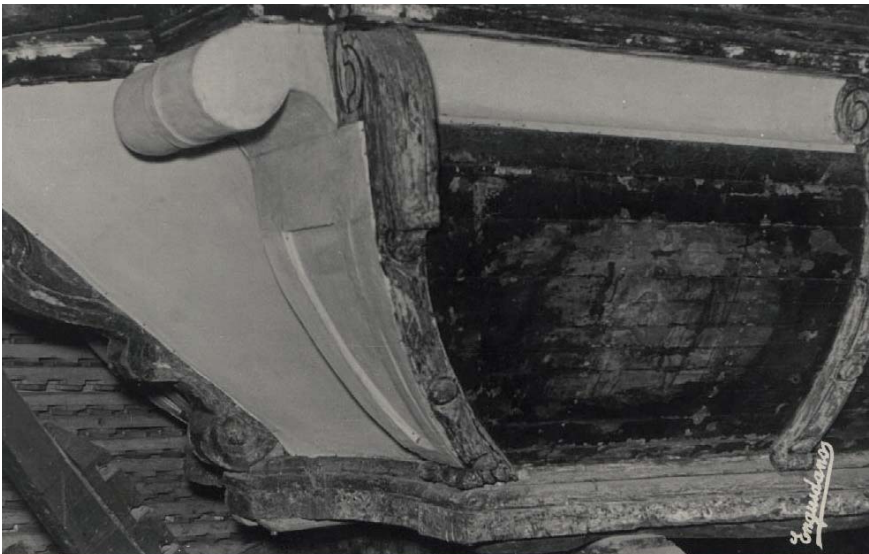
Detalle de la estructura tras la reconstrucción de algunas partes.
